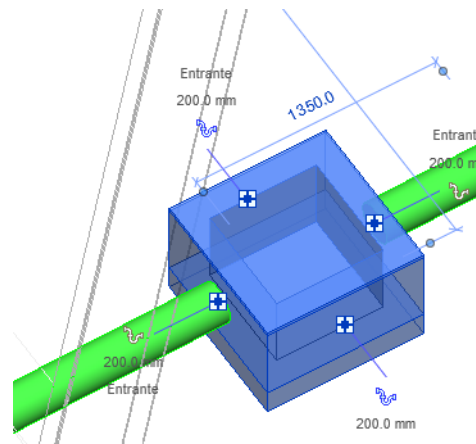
Detalle de arqueta creada con conexiones de diámetro 200 mm.
